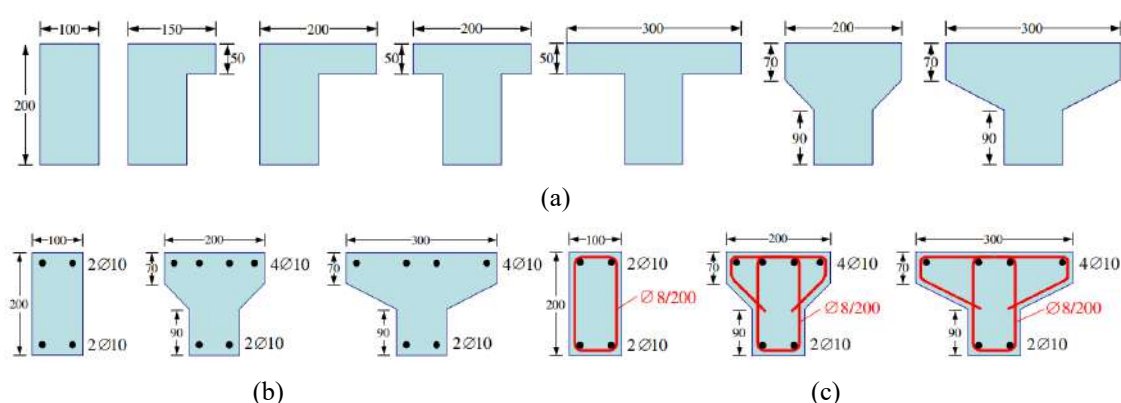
Seção transversal e distribuição de armadura longitudinal e transversal: (a) grupo sem armadura, (b) grupo com armadura longitudinal, e (c) grupo com armadura longitudinal e transversal [110].
